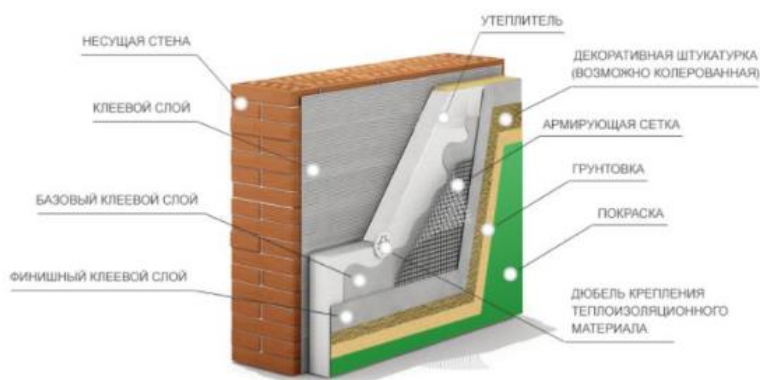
Устройство штукатурного утепленного фасада
